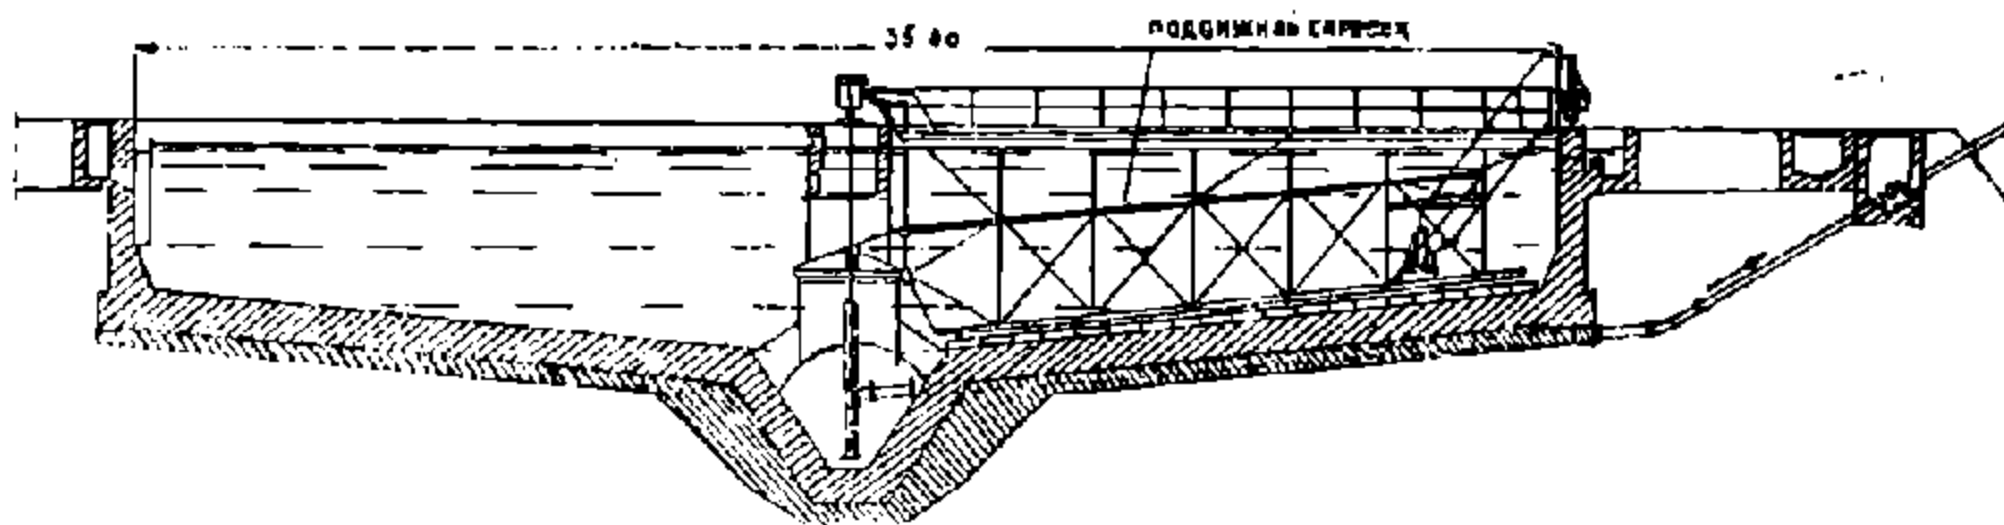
Квадратный радиальный отстойник установки Штансдорф (Берлин).
